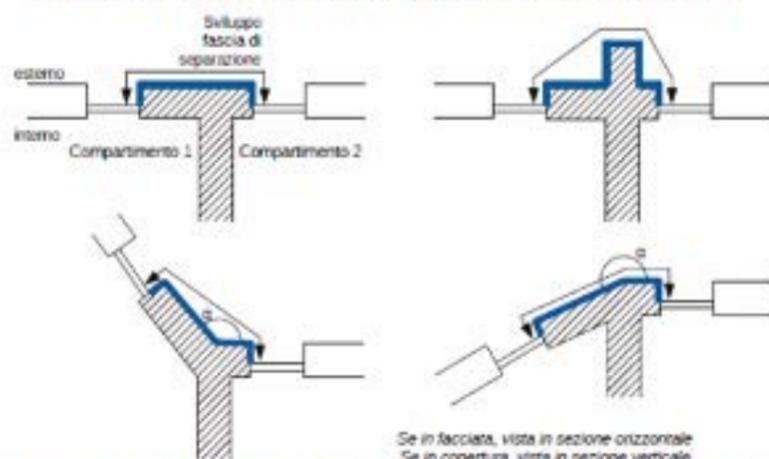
Esempi di fascia di separazione verticale in facciata o in copertura
